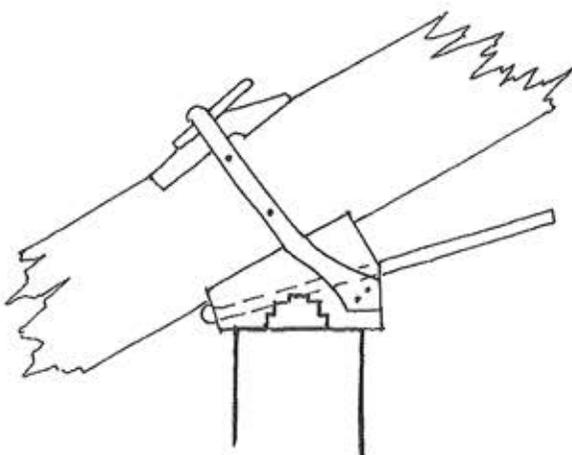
h – Particolare del nodo di collegamento tra pilastro e puntone con presenza di tirante metallico.
